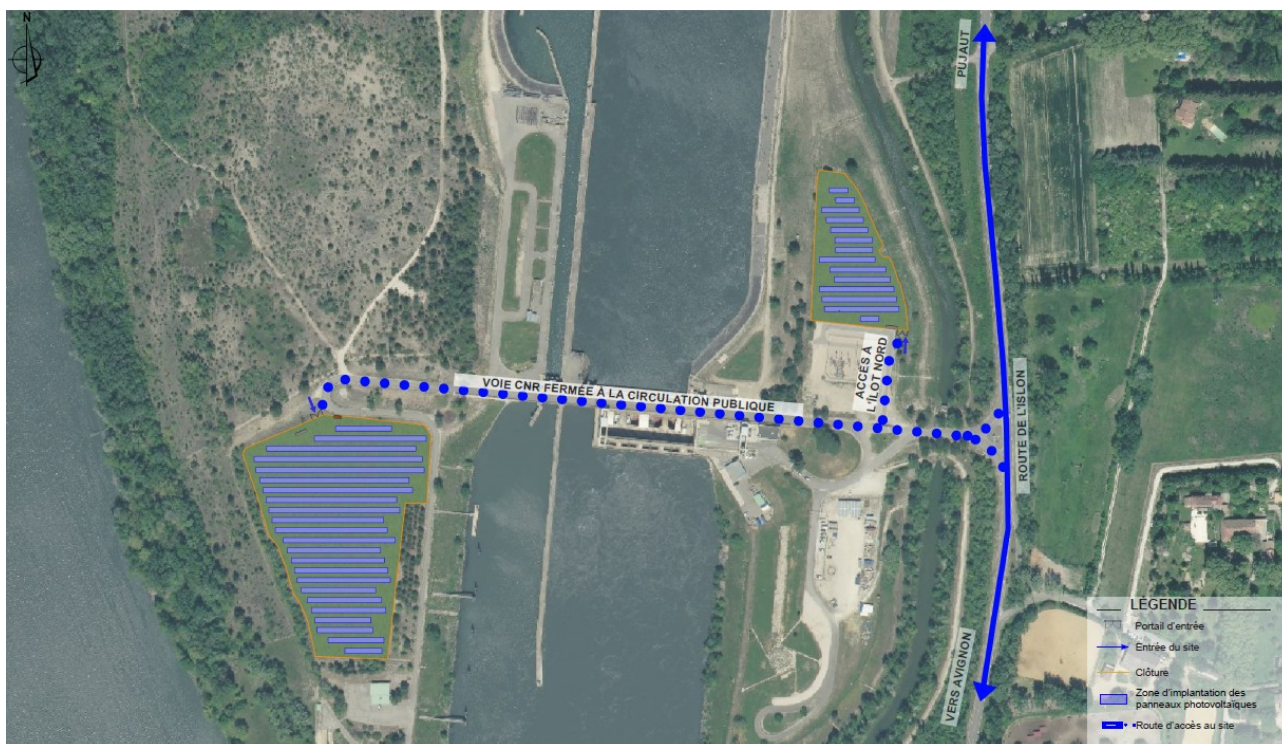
plan masse du projet. Source : dossier de permis de construire.
